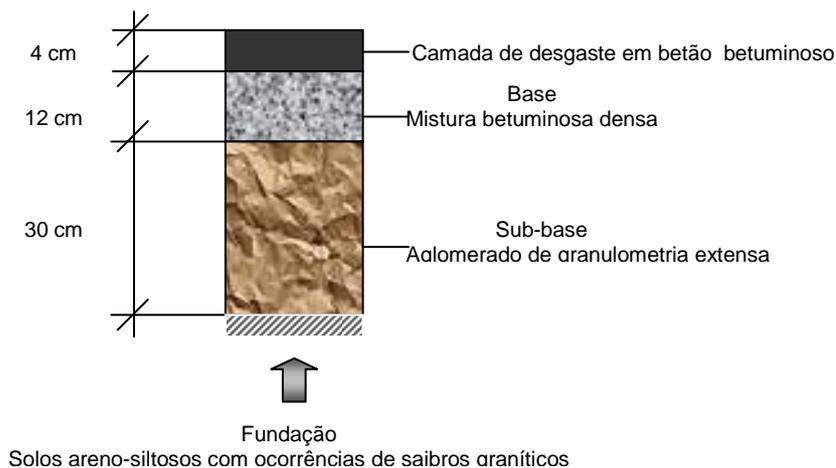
Estrutura inicial do pavimento aquando da sua construção em 1992 (IP2)
